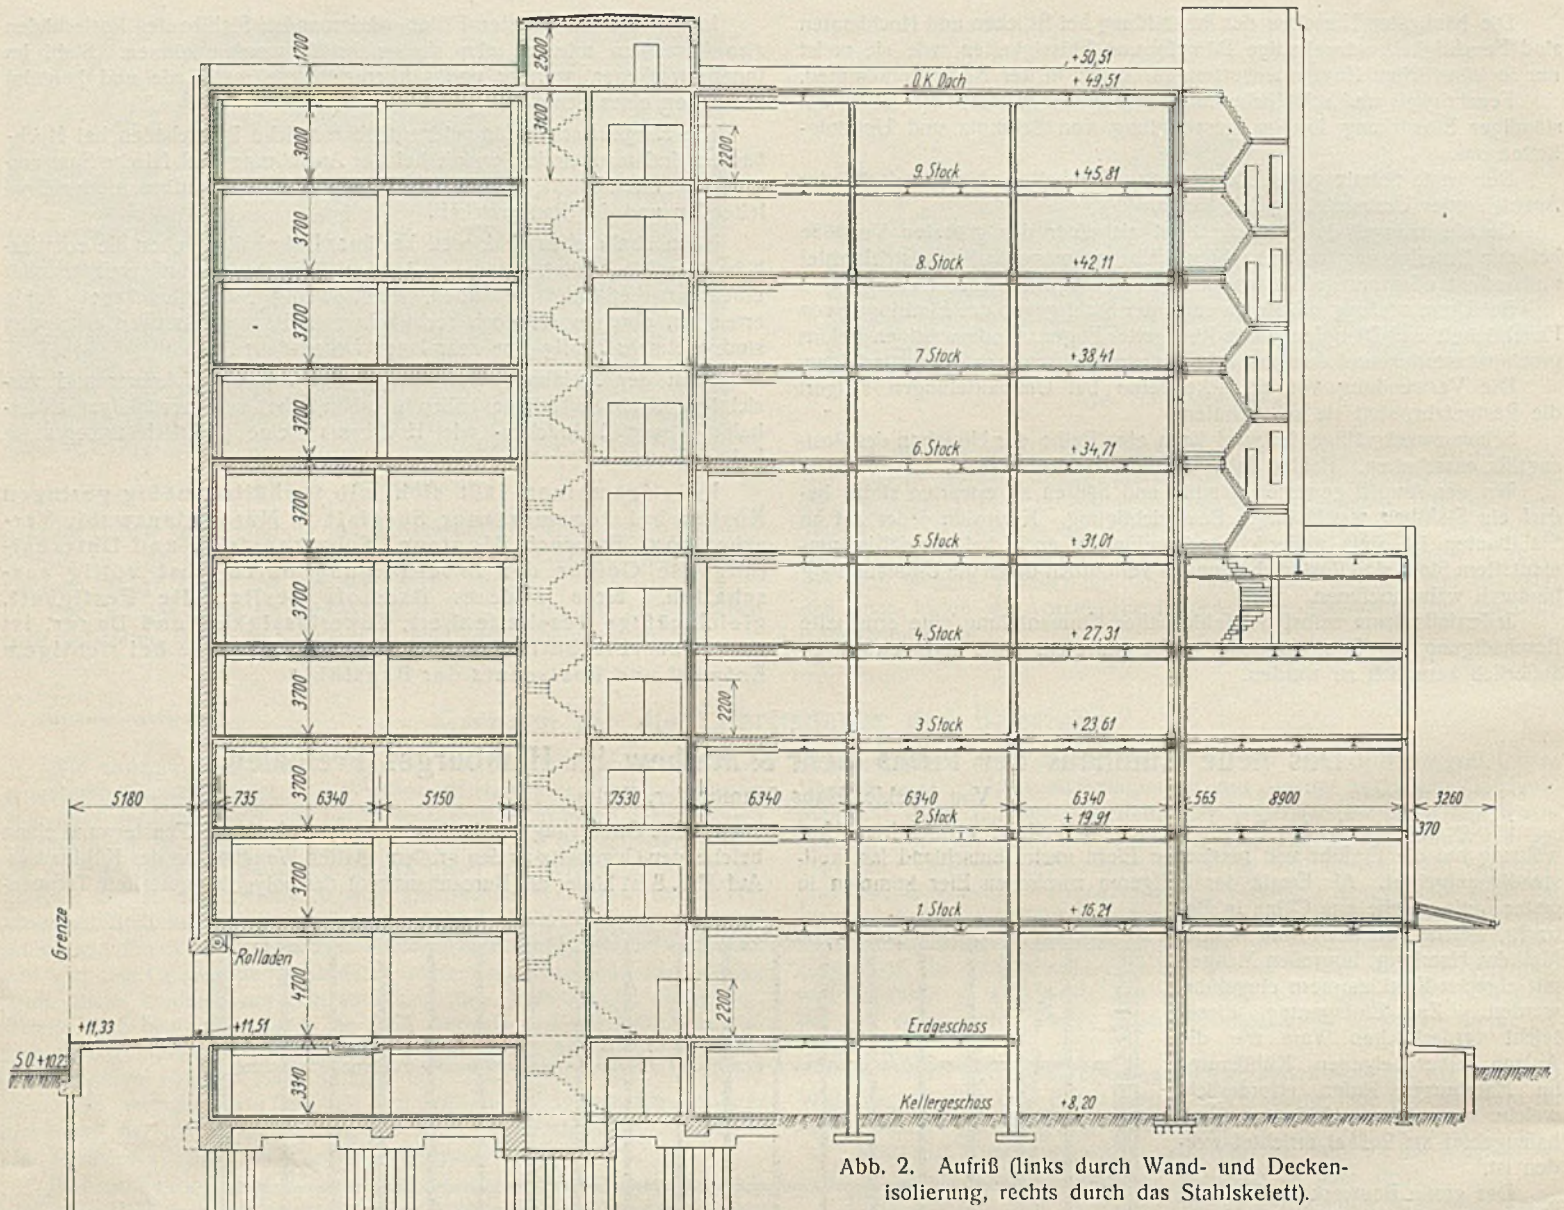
Außriß (links durch Wand- und Decken-isolierung, rechts durch das Stahlskelett).
